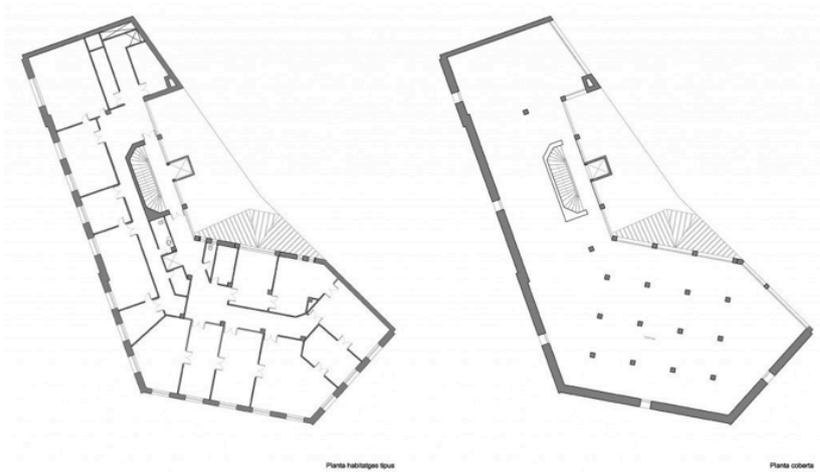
Planta do pavimento tipo de habitações e planta de cobertura
